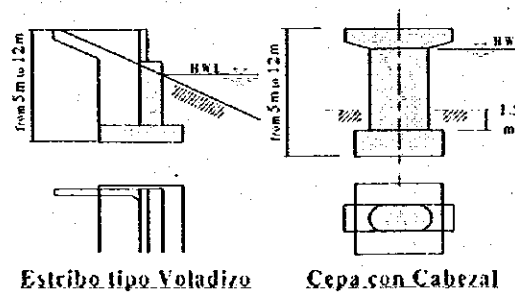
Tipo de Puente Estándar (Infraestructura)
